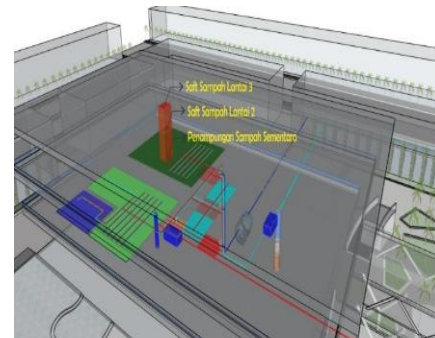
Perancangan Utilitas Drainase pada Bangunan Pasar
